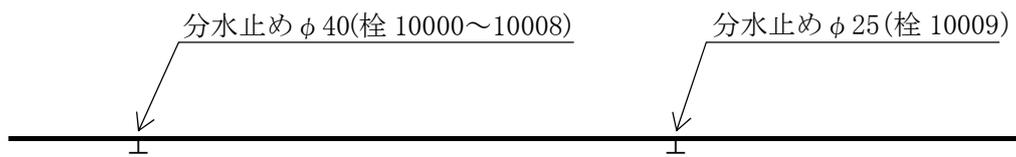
配水管及び他の給水管から切断した箇所の平面図
